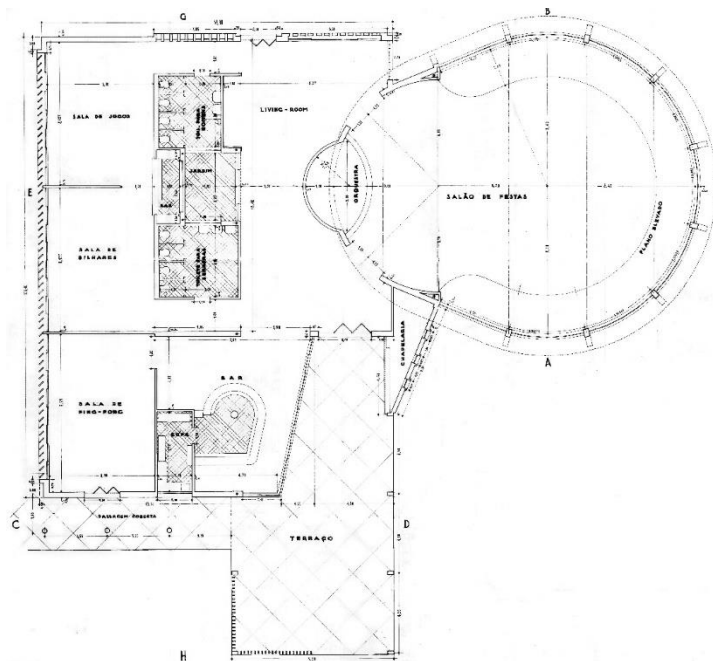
Planta baixa do projeto conforme foi construído, 1952.
